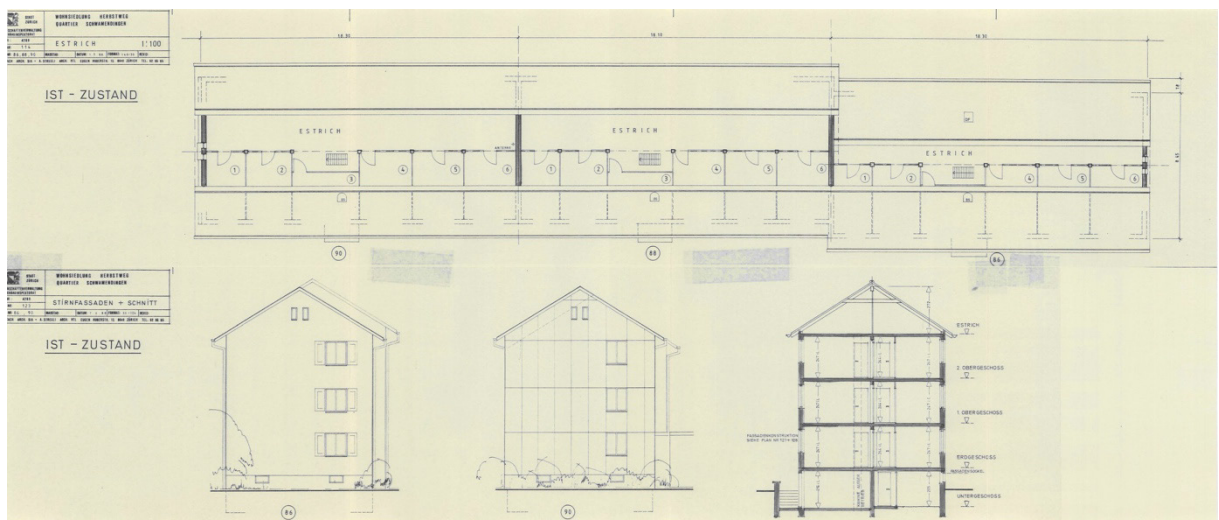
Grundriss und Schnitte der Überbauung Herbstweg 96, Quelle: Stadt Zürich, AHB.
